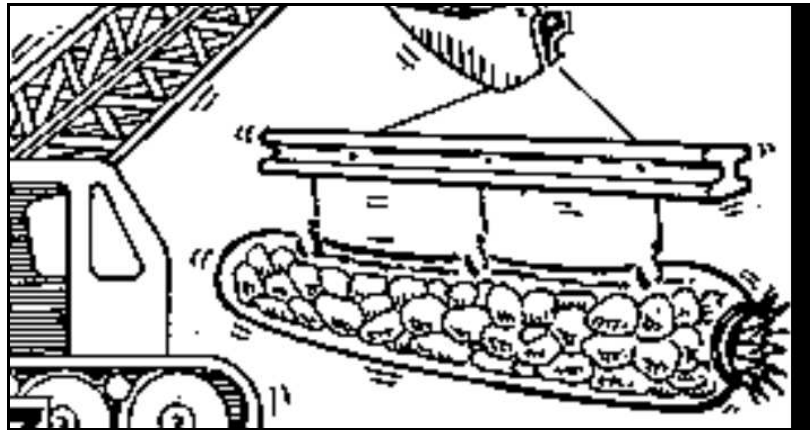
Detalhe do sistema de içamento normalmente utilizado para instalação dos gabiões saco.
